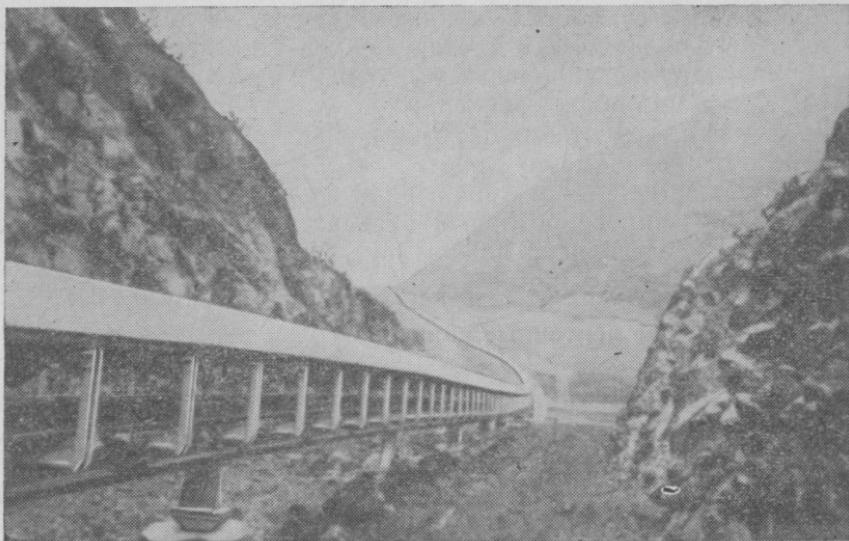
Вид на изгибающийся конвейер со стороны рудника
